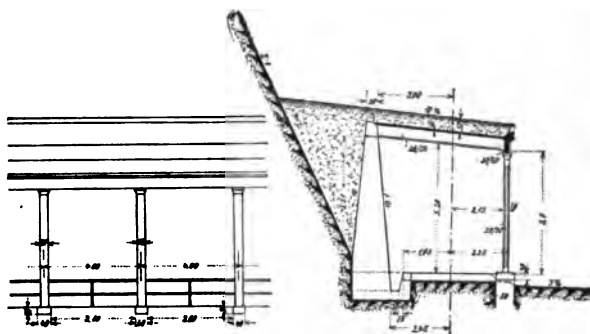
Ansicht und Querschnitt der Steinschlag-Schutzgalerie zwischen Auzza und Canale.
